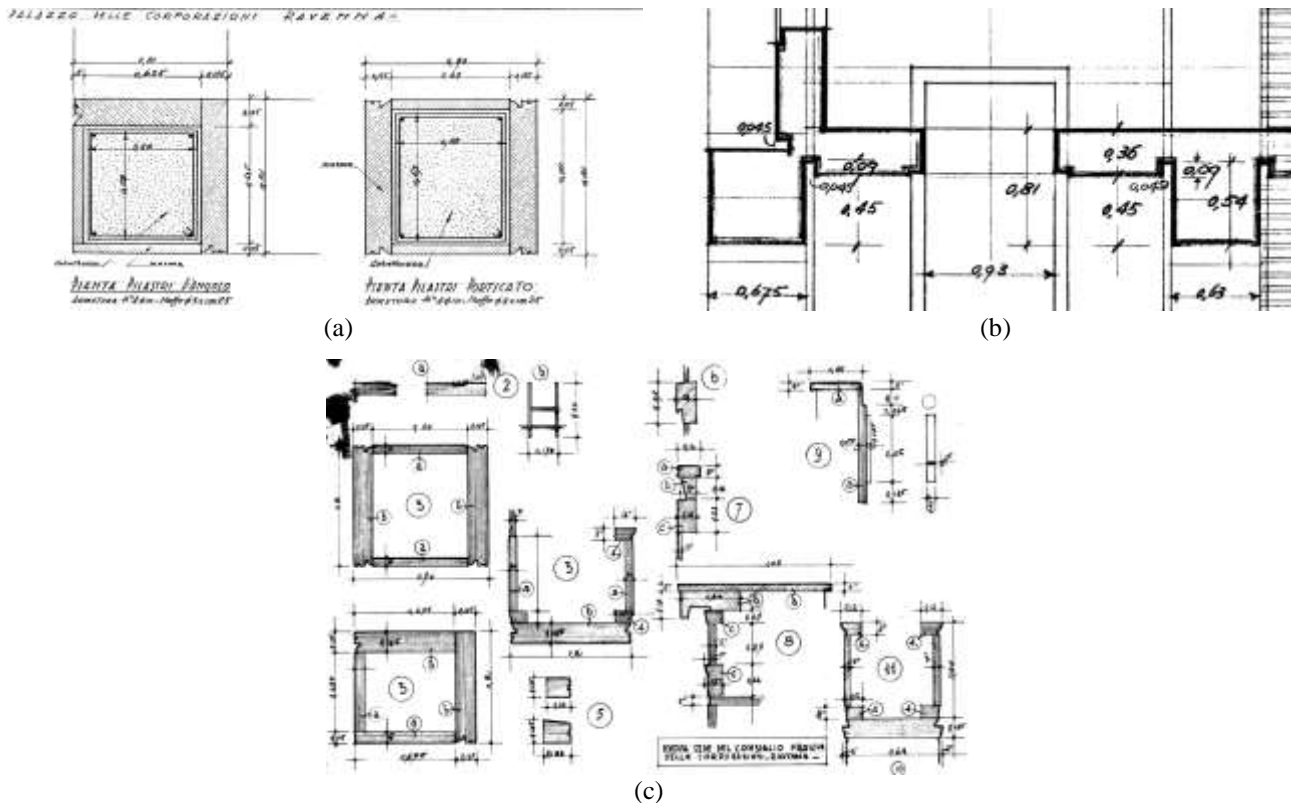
Spessori del rivestimento in finto travertino applicato (a) ai pilastri del porticato, (b) alla facciata dell'edificio e (c) ad altri elementi (progetto preliminare).
